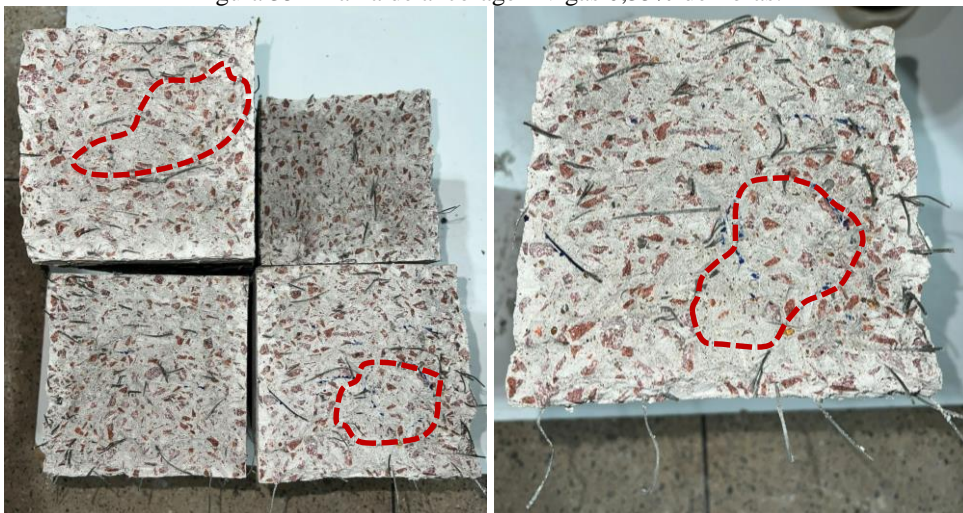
Detalhamento do concreto vigas 0,35% de fibras.
